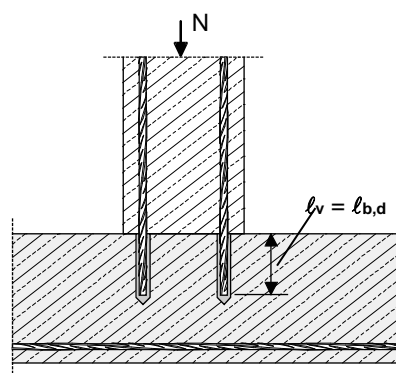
Recouvrement d'armatures pour la liaison de dalles et poutres
